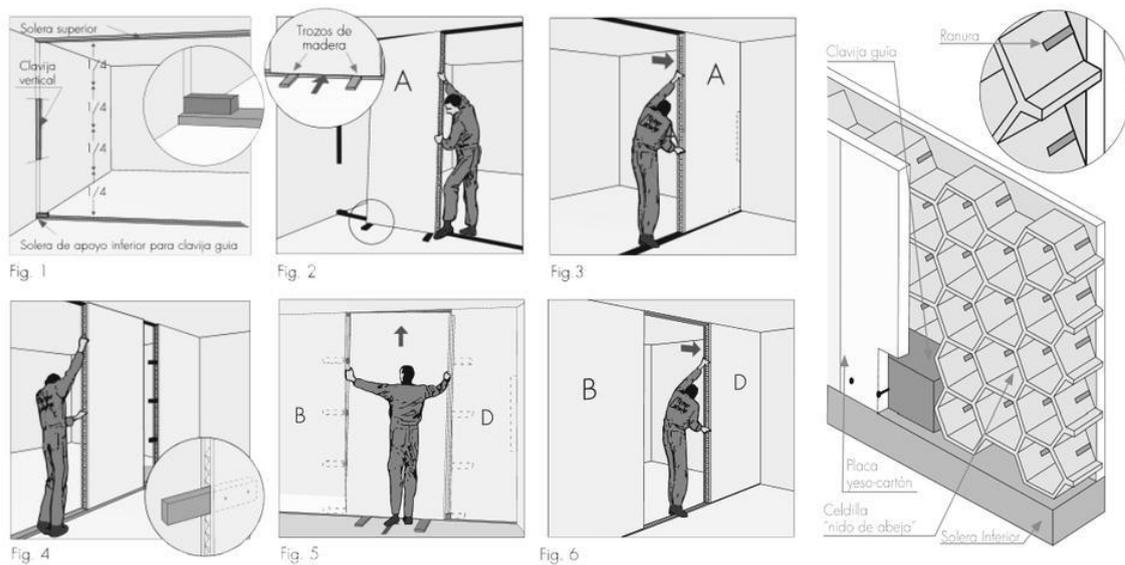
Detalle de Tabique seca pre armado Panelgyp – Fuente ArchDayly
